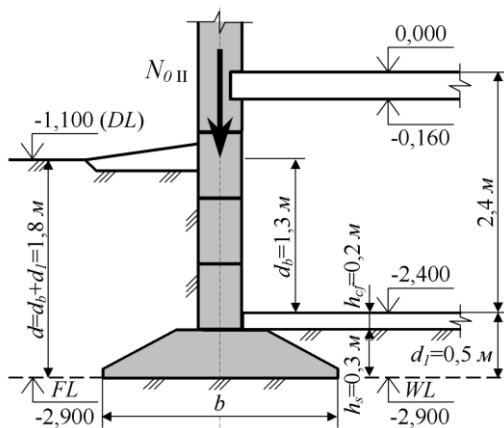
Схема до визначення ширини стрічкового фундаменту мілкового закладання під центрально навантажену стіну житлового будинку
